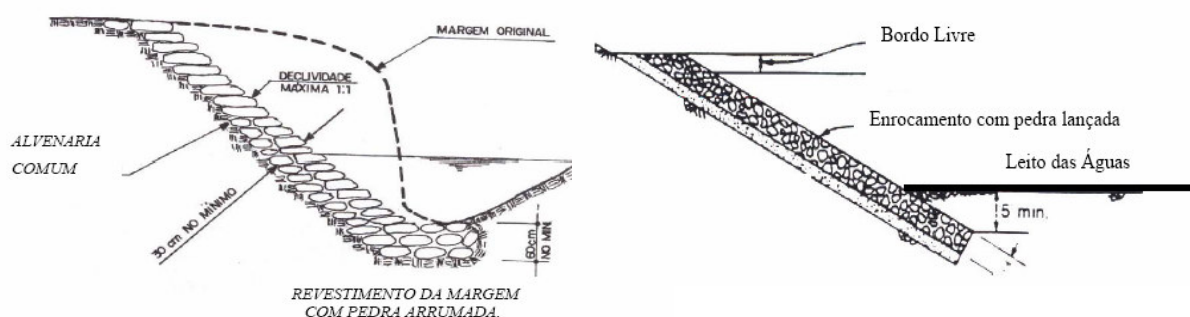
Proteção Direta – Enrocamentos com pedras: arrumadas e lançadas
